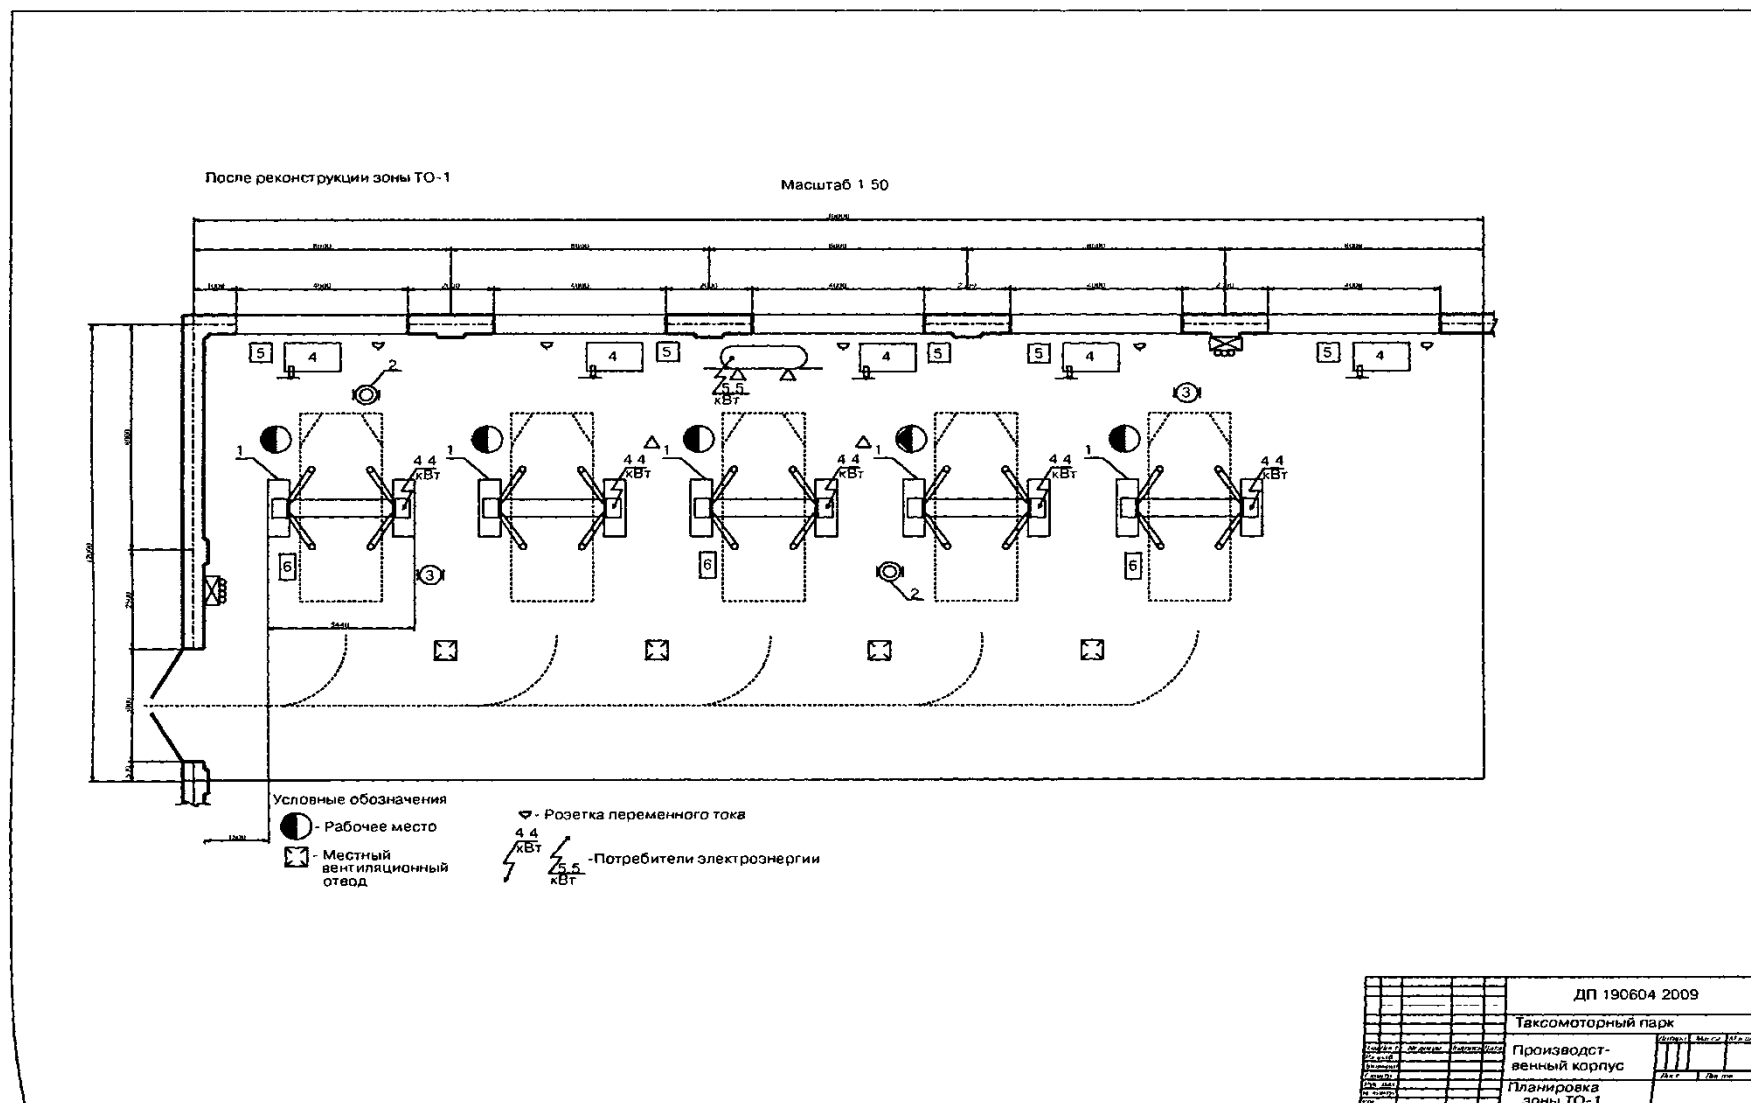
Планировка зоны ТО-1 таксомоторного парка
